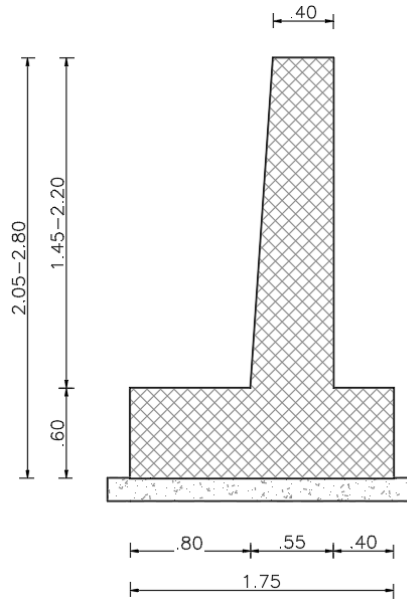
Sezione trasversale Muro Tipo 2 – Viabilità NV02B
